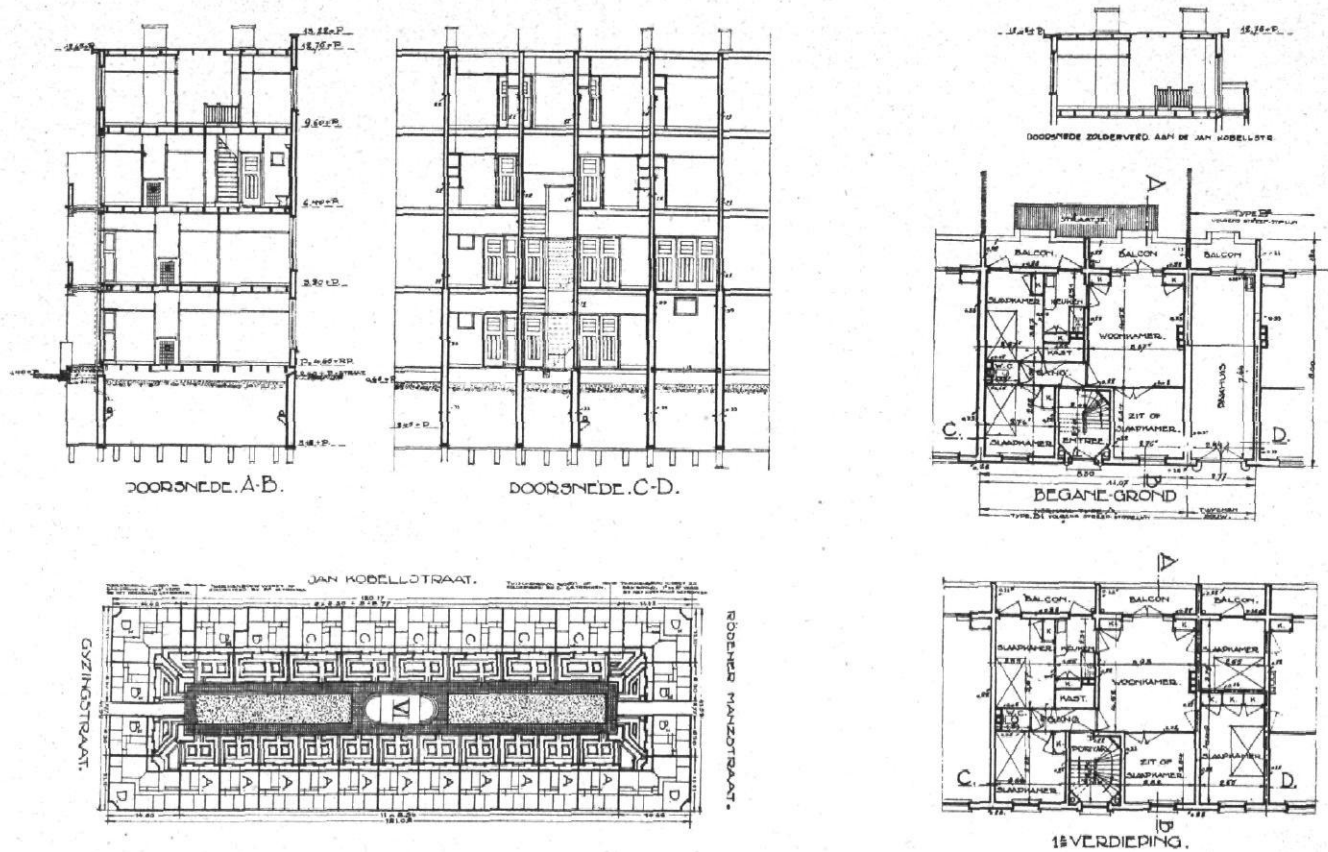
bis 9 / „Fusschendyken“ Block V und VI / Gemeindlicher Wohnungsbau, Rotterdam / Querschnitte, Grundrisse, Blockplan
